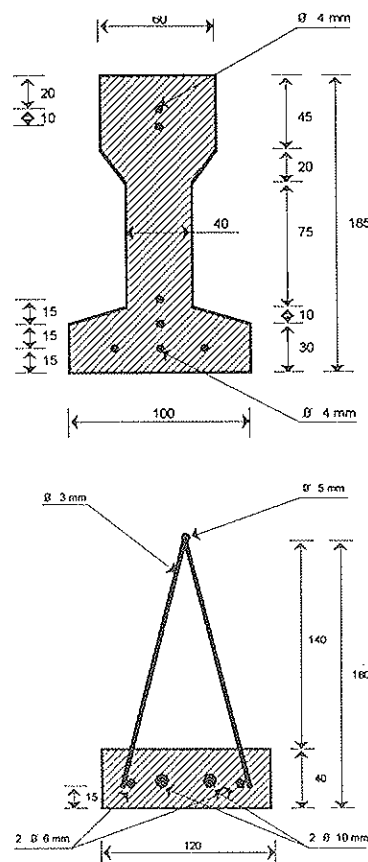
Detalle de viga autoresistente pretensada y semivigüeta armada. (Cotas en mm).
